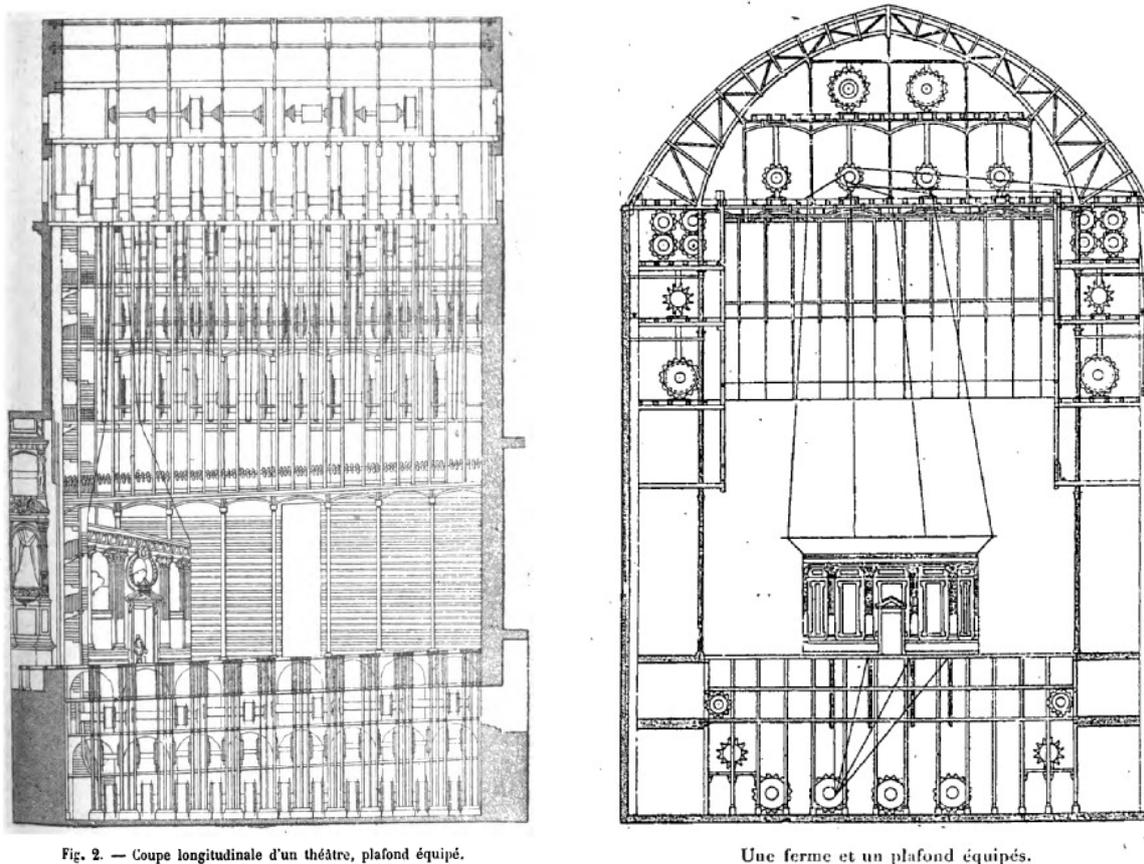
Coupe longitudinale d'un théâtre, plafond équipé.
